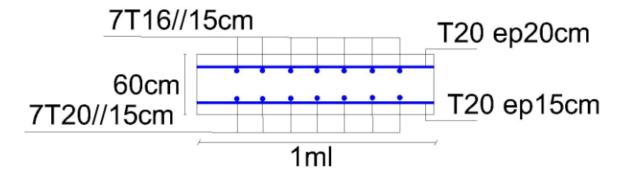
Coupe ferraillage dalle radier sens x-x
